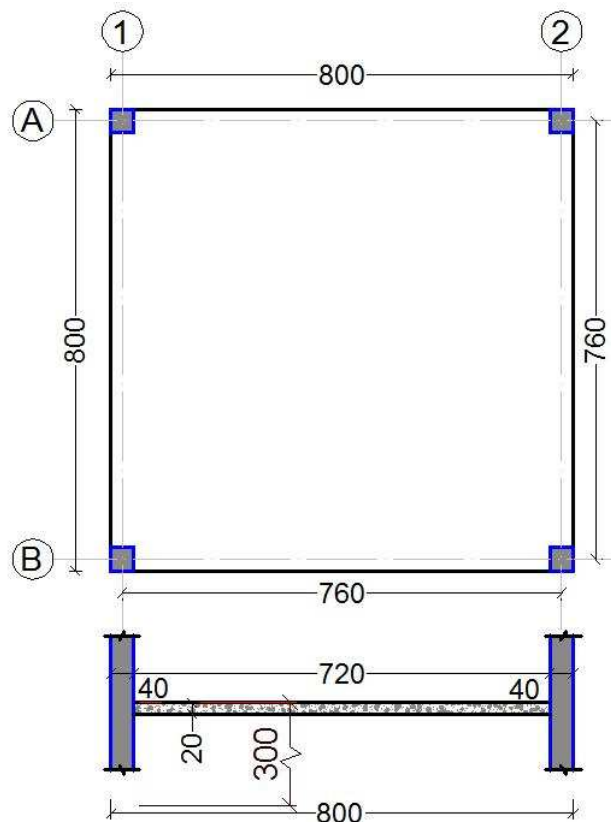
Planta baixa e elevação da FÔRMA_1
